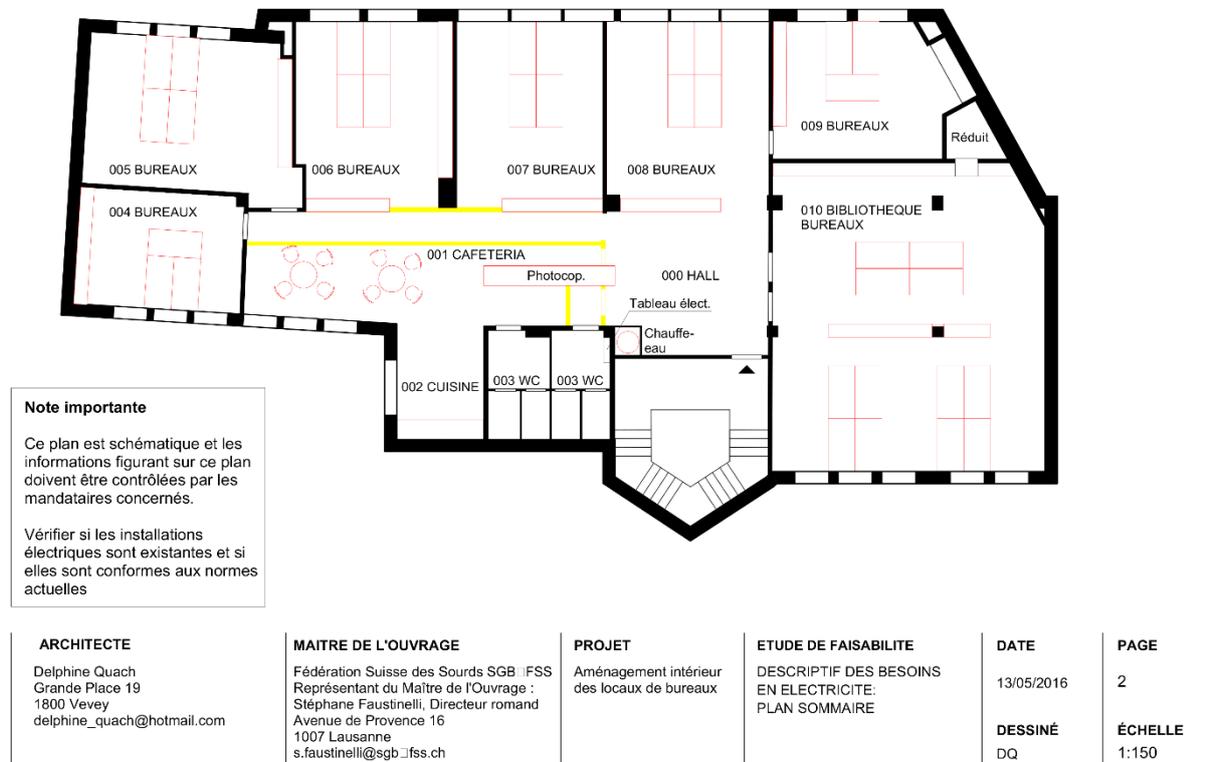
Plan De l'étage, bureau de la FSS, photo personnelle.
